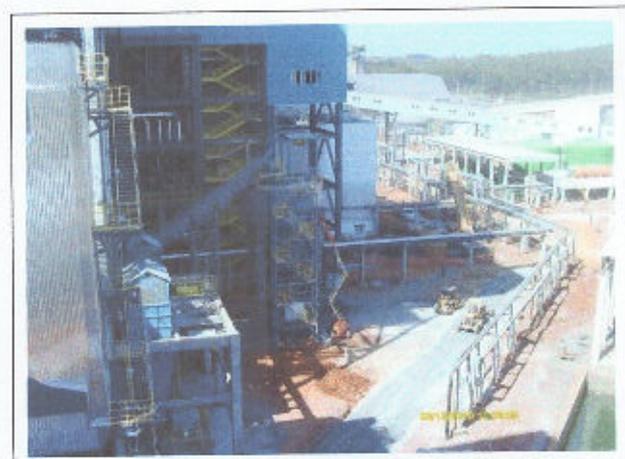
Área do Silo de Cinza Pesada - acesso em fase de pavimentação
